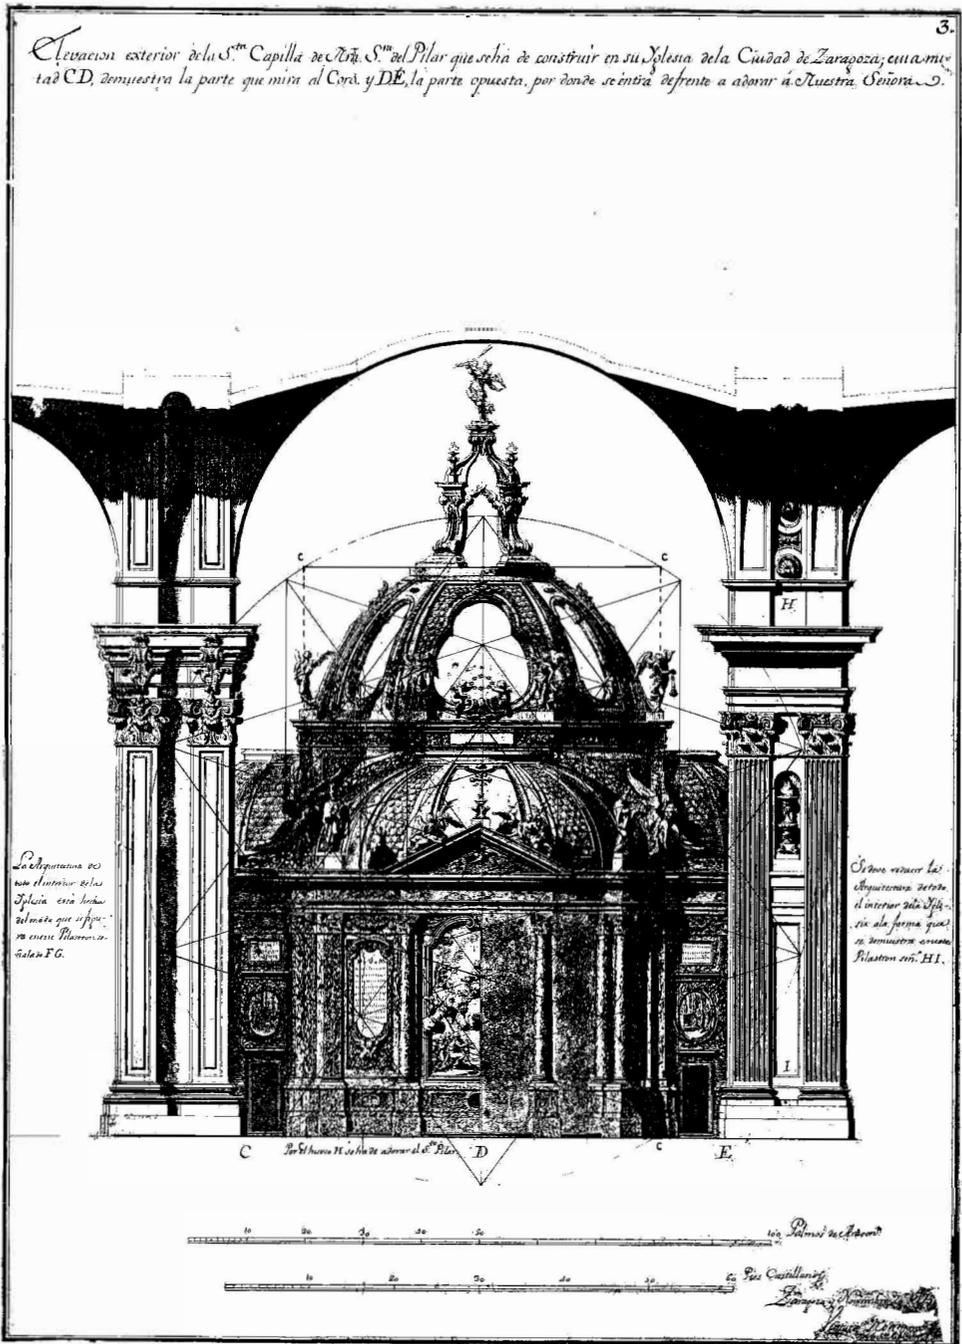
«Sección áurea». Alzado. Decágono estrellado.
